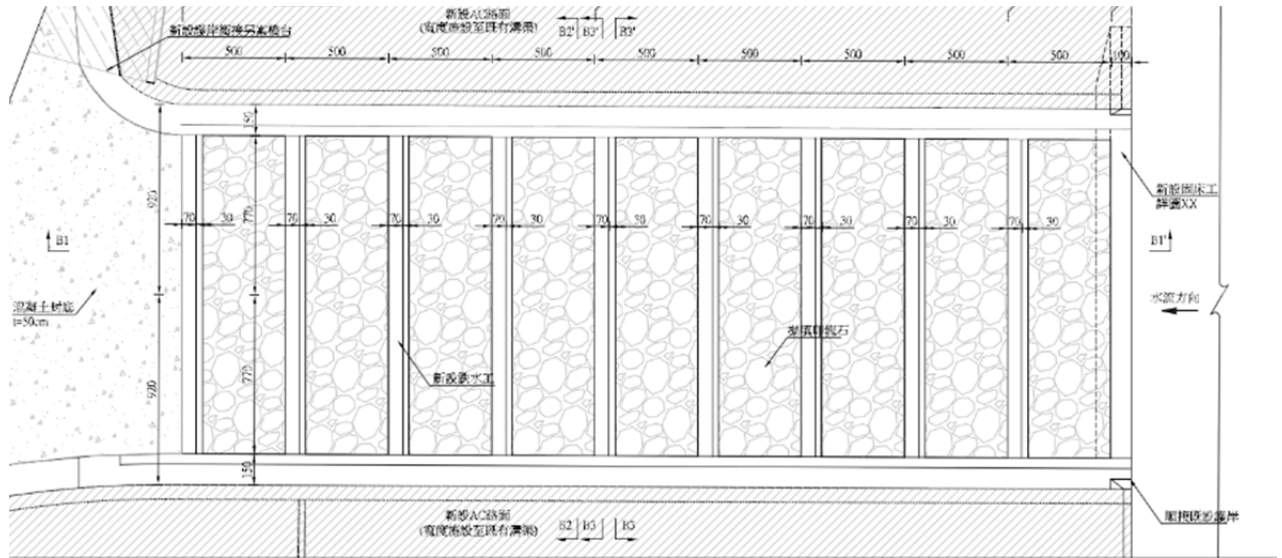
南勢坑溪-階梯式消能工平面示意圖
